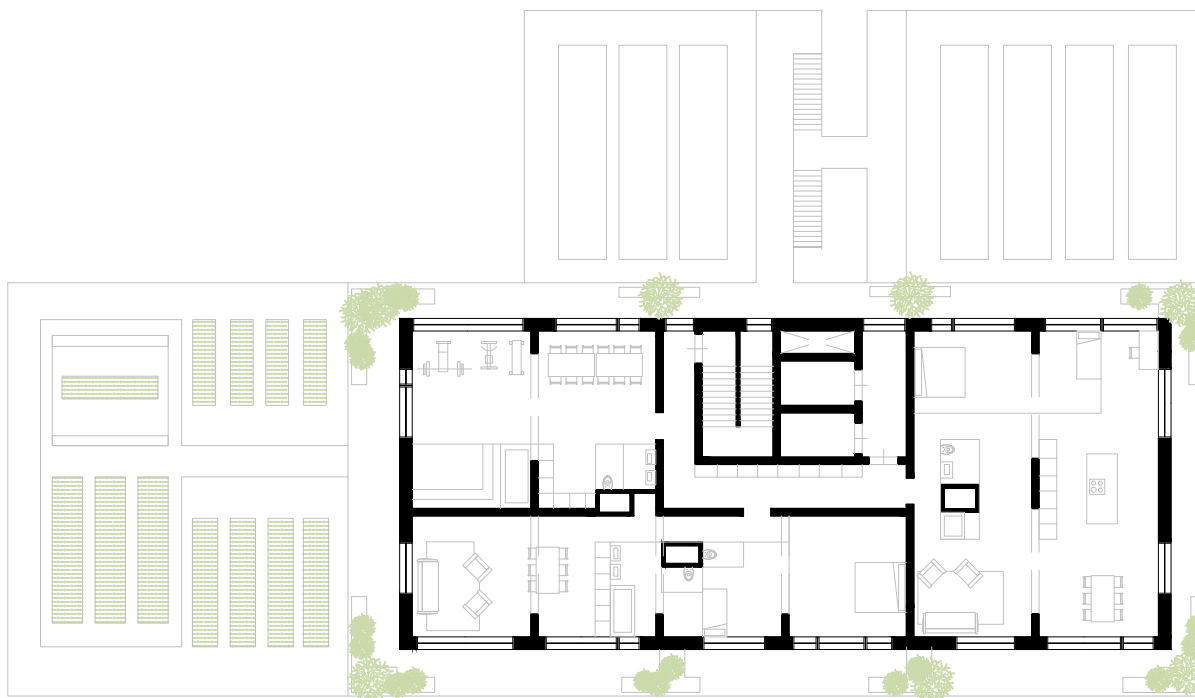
Plano de prototipo de planta con tres viviendas del edificio BSH20A a escala 1:200.
